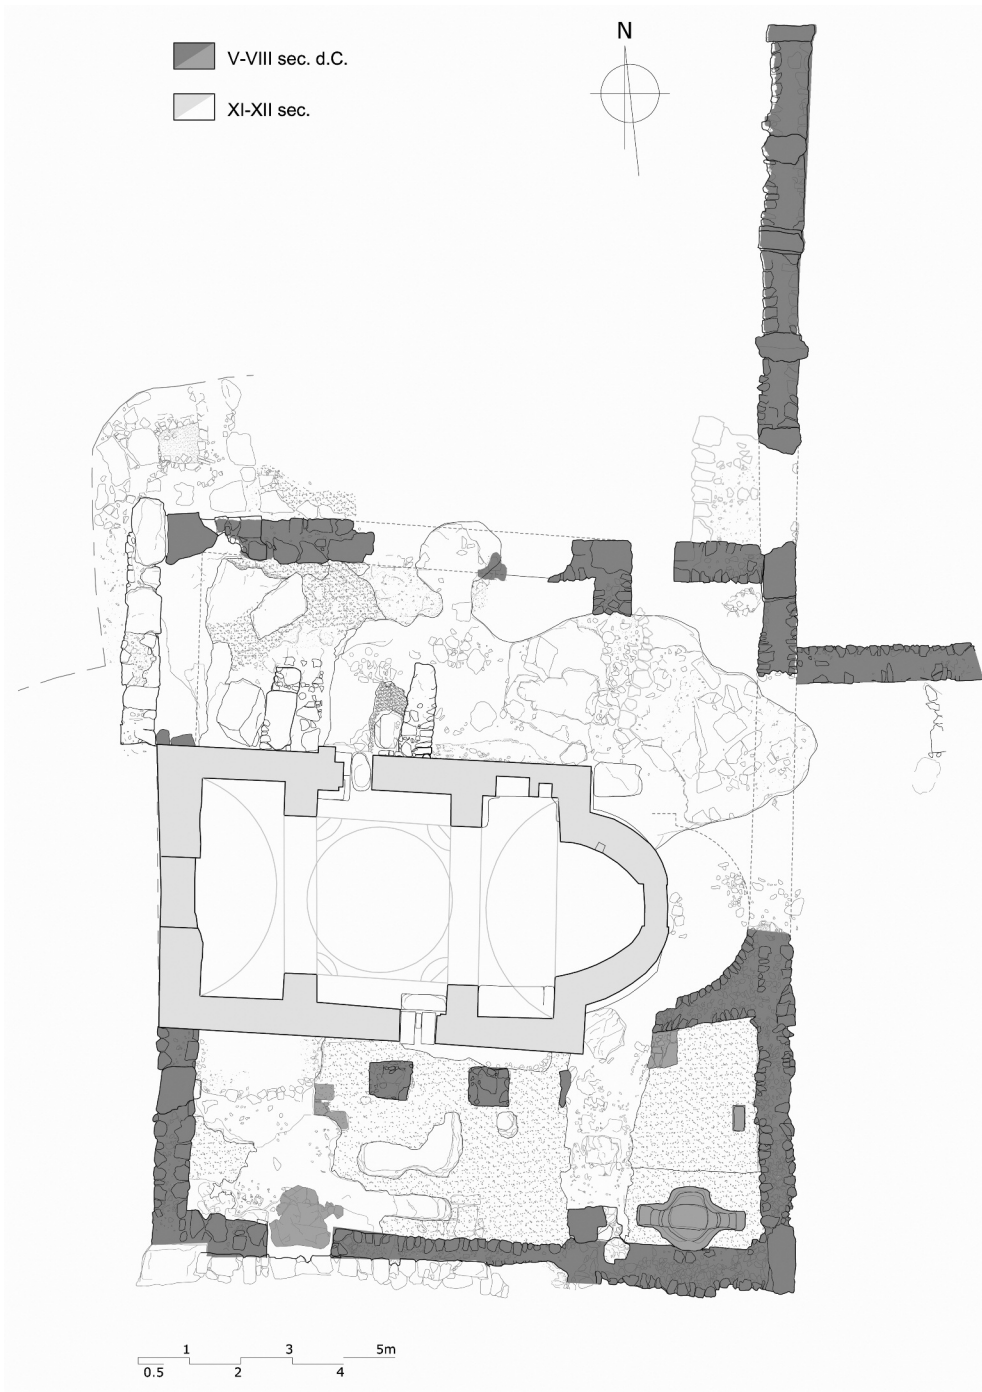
Marettimo. Planimetria dell'area della chiesa
